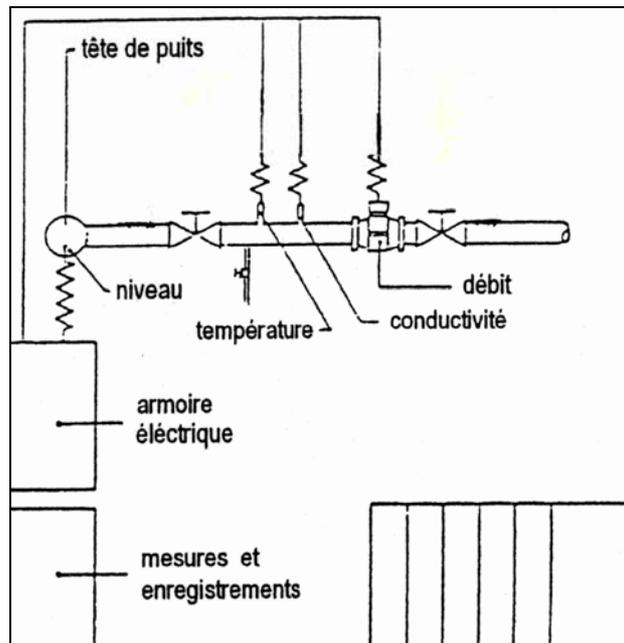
Vue en plan du local technique du forage Trois Puits Est
